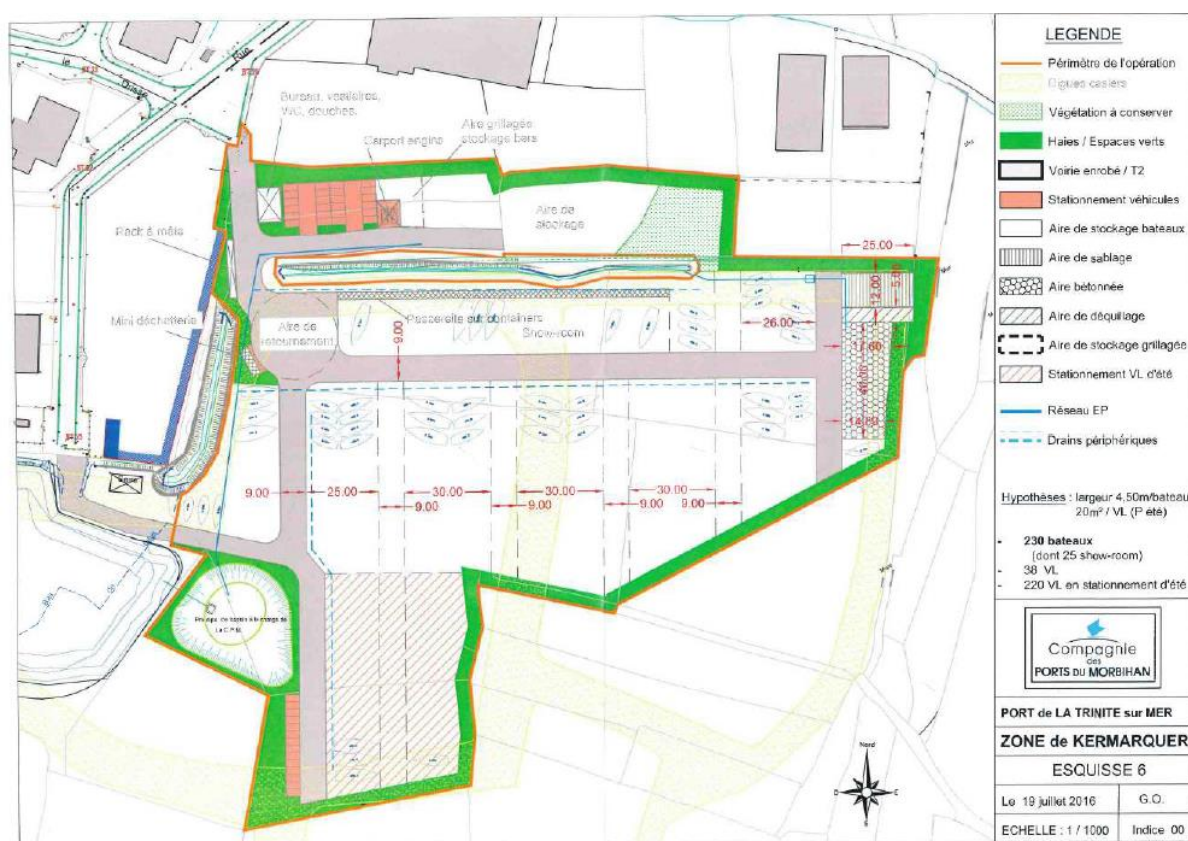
Plan projet de l'extension sud (CPM, juillet 2016)
